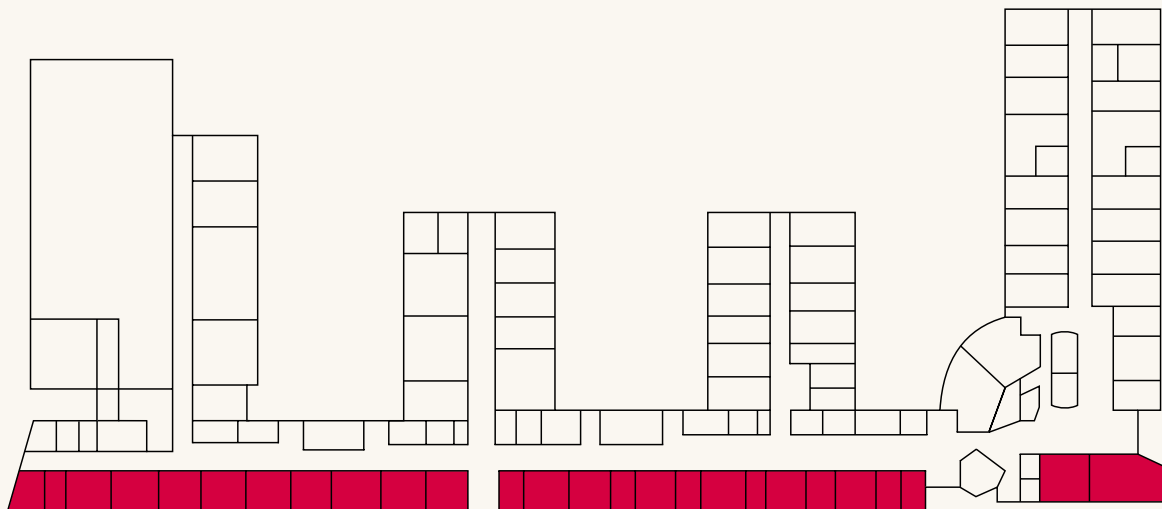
Grundriss des UFT - die Labortrakte (oben) weisen nach Norden, der Bürobereich (unten) ist nach Süden ausgerichtet.
